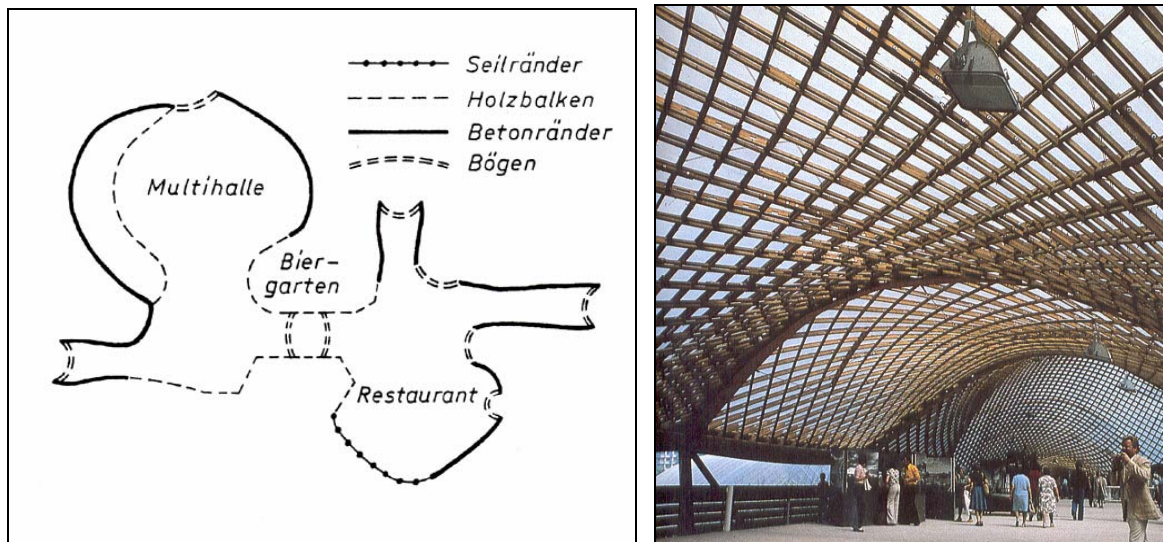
Multihalle Mannheim: links: Grundriss und Randträgerarten, rechts: Innenansicht. (Quellen: [98] bzw. [34])
